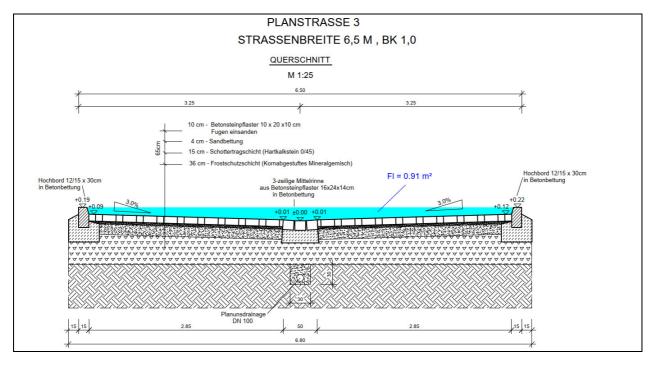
Baugebiet "Bellingholz-Süd", Querschnitt Planstraßen, DW- Ingenieure GmbH, unmassstäblich
